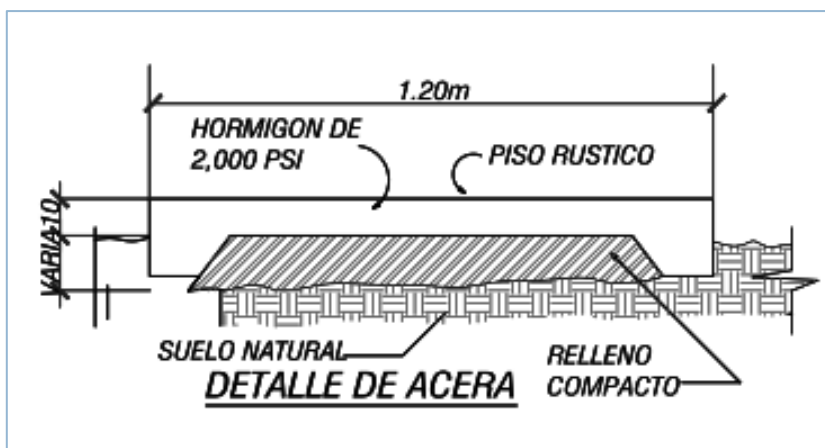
Detalle de acera. Fuente: Planos de anteproyecto
